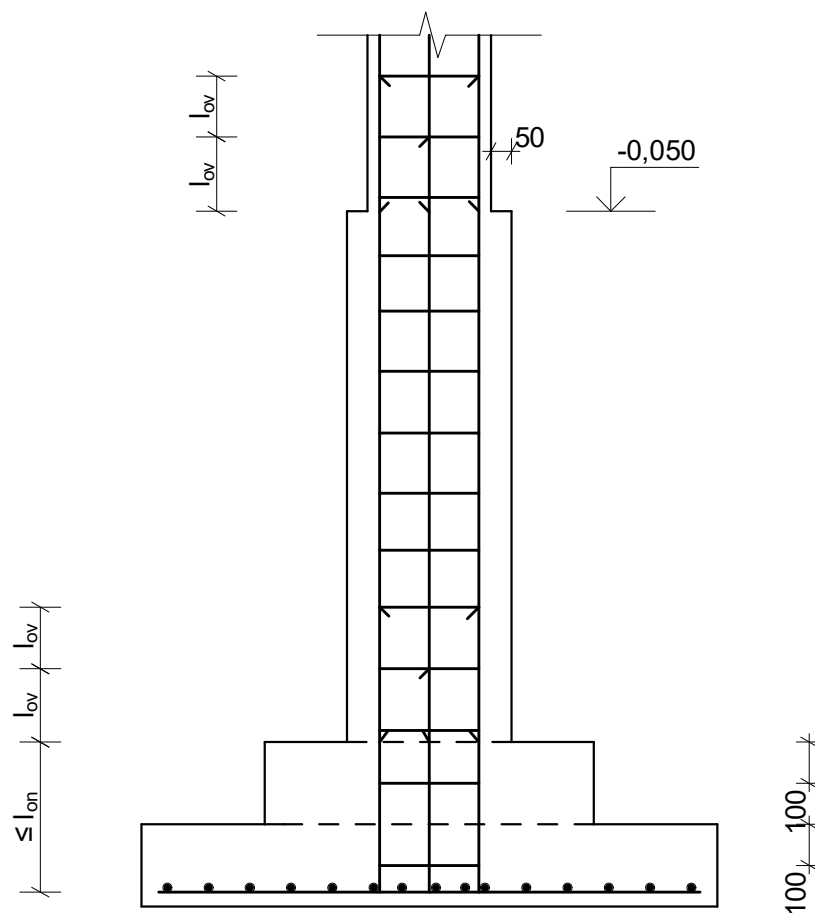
Конструкція фундаменту під монолітну колону
